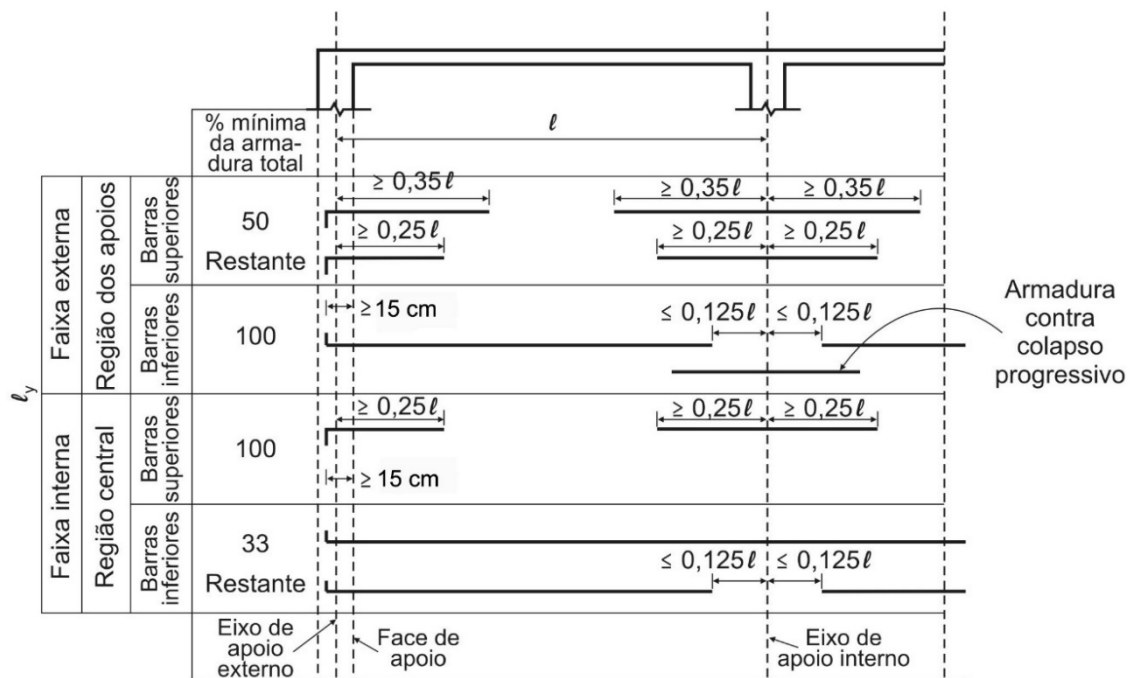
Detalhamento da armadura contra colapso progressivo em lajes sem vigas (ABNT NBR 6118, 2014)
